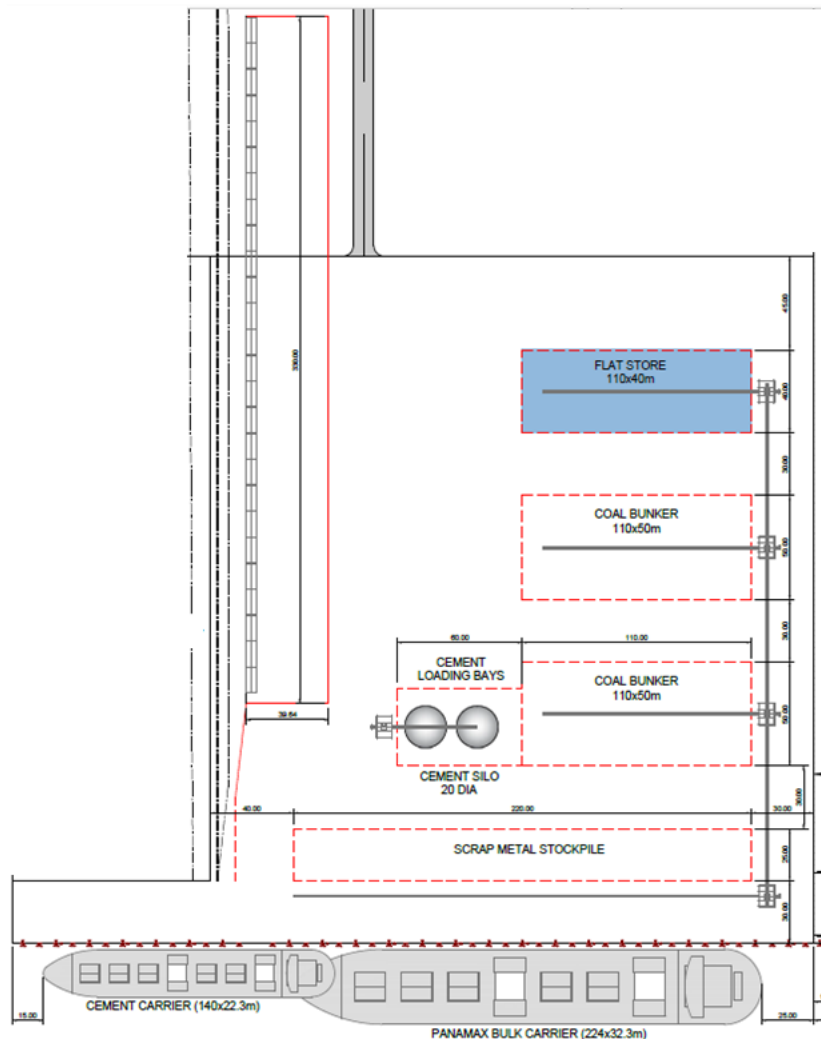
Planimetria e terminalit të mallrave rifuxho
